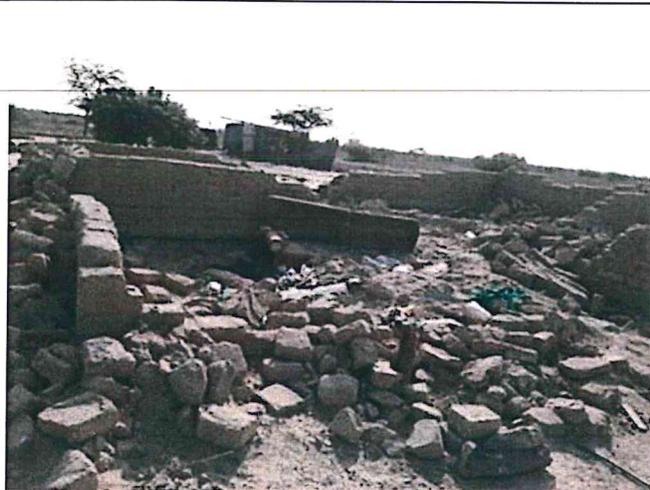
Viviendas de adobe, inhabilitada por el colapso.
